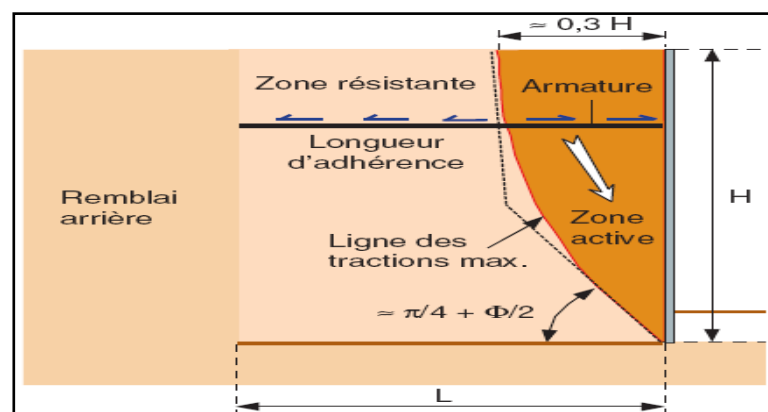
Stabilité interne d'un mur de soutènement en terre armée
